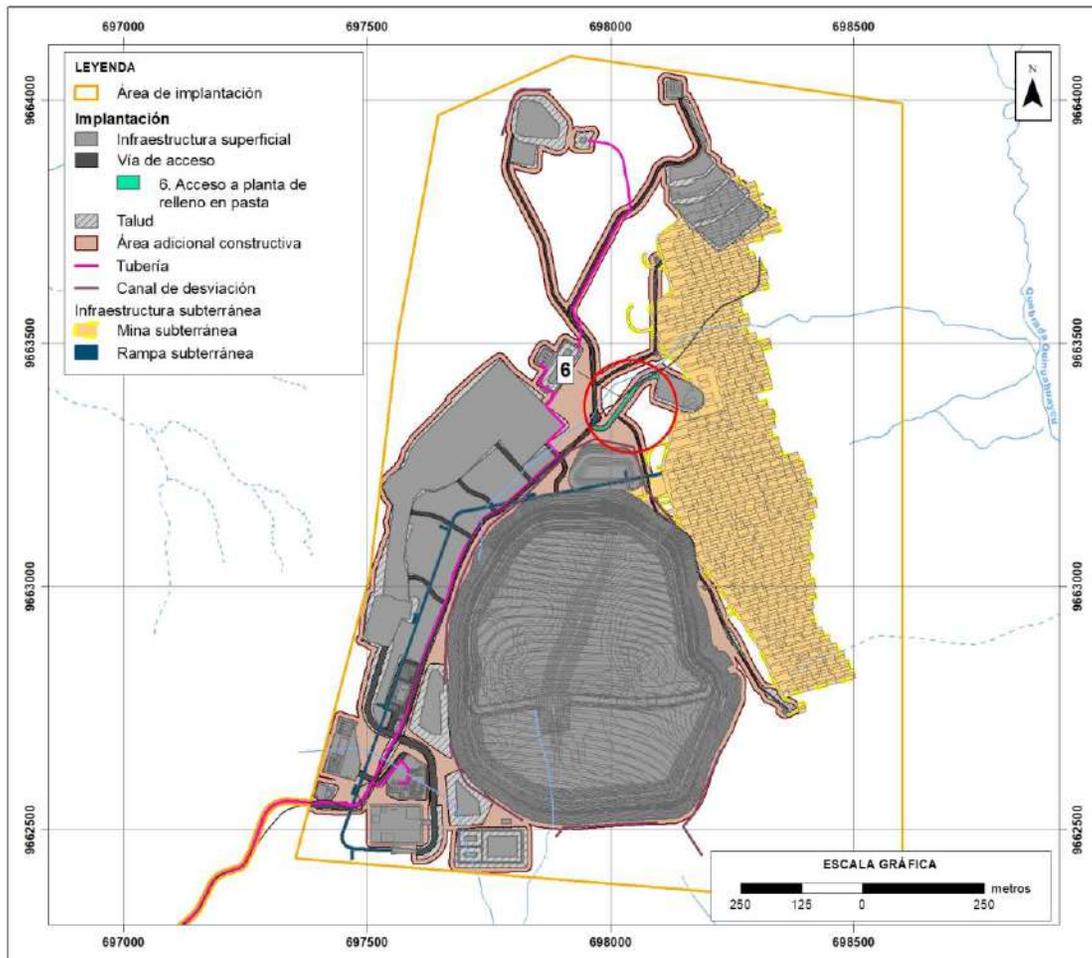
Ubicación del Acceso a la Planta de Relleno en Pasta
